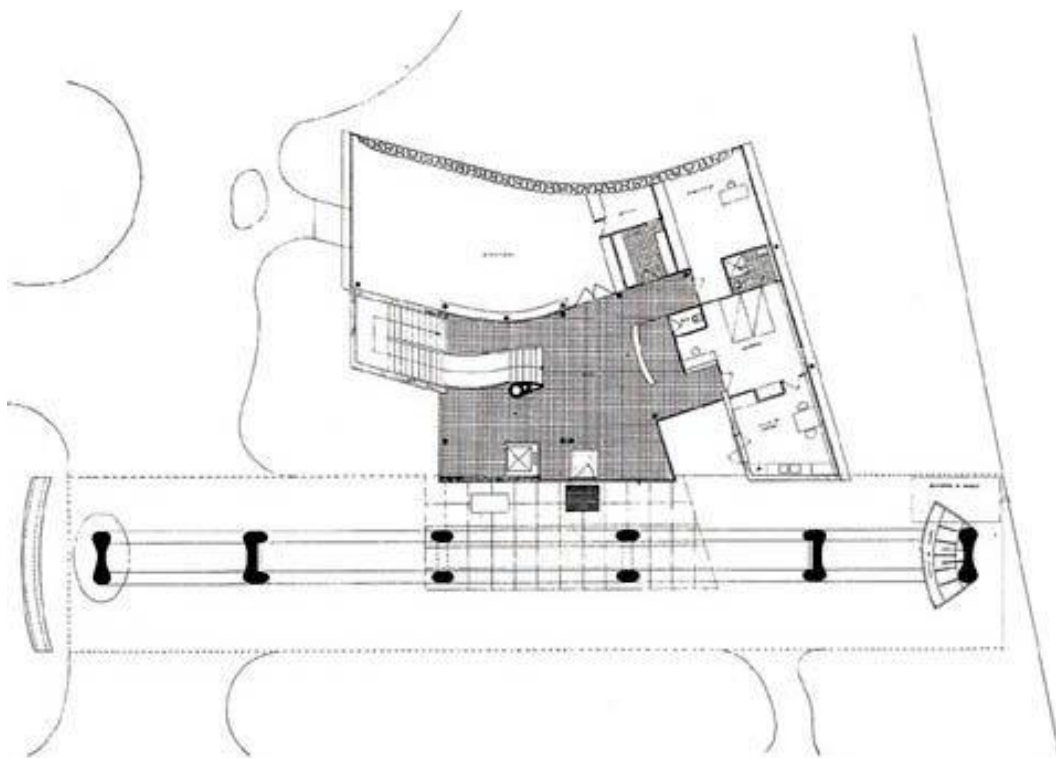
Pianta piano terra - Fonte: www.architect.com
